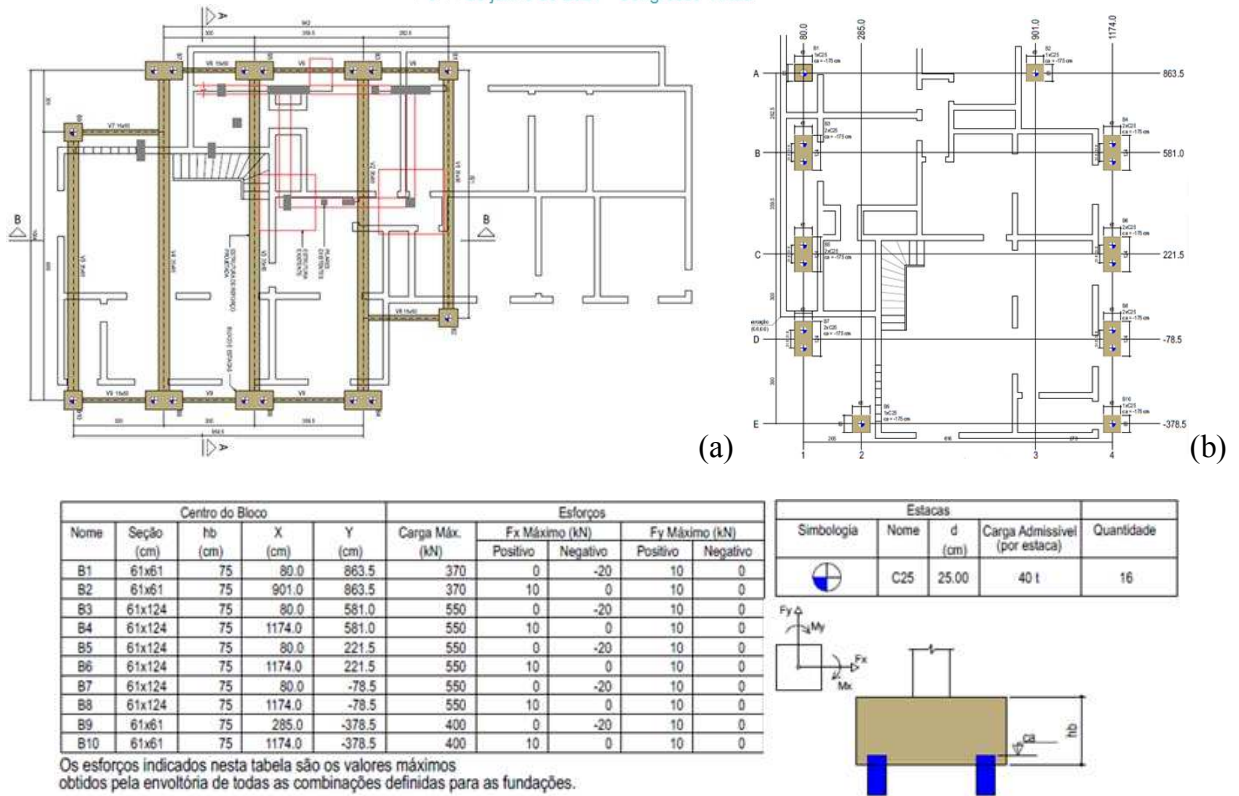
(a) Planta de formas do pavimento 1 (Nível -65), (b) Planta de locação das estacas e blocos e (c) Detalhes dos blocos e estacas. Fonte: ZSE Engenharia (2020).
